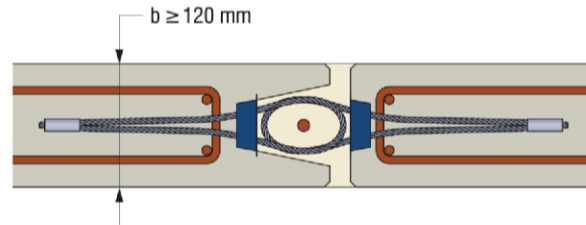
Wand – Wandverbindung (*planer Einbau*)
